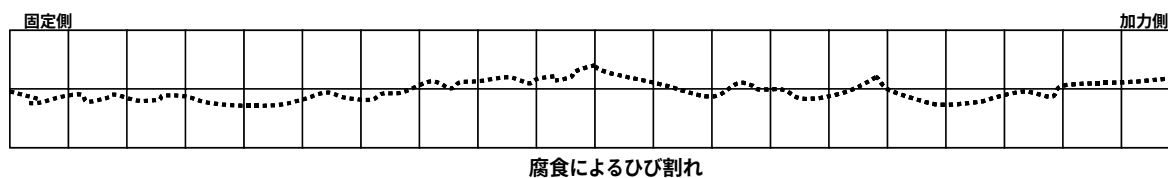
断面減少率5.3%試験体のひび割れ発生状況
